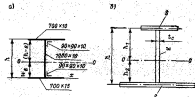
Сечения флора: а — клееного; б — сварного.
